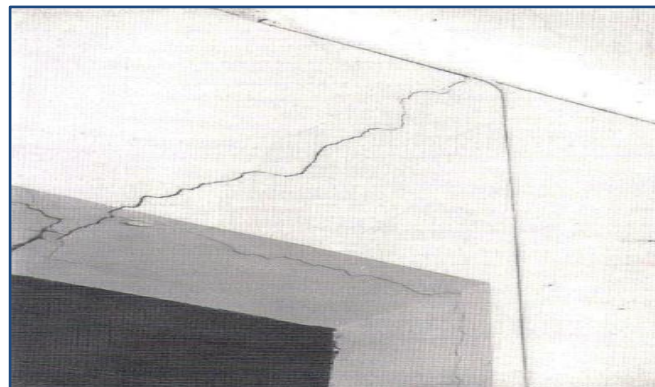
Fisuración típica en vigas simplemente apoyadas, de Rodríguez, (2011), Tesis de grado.
